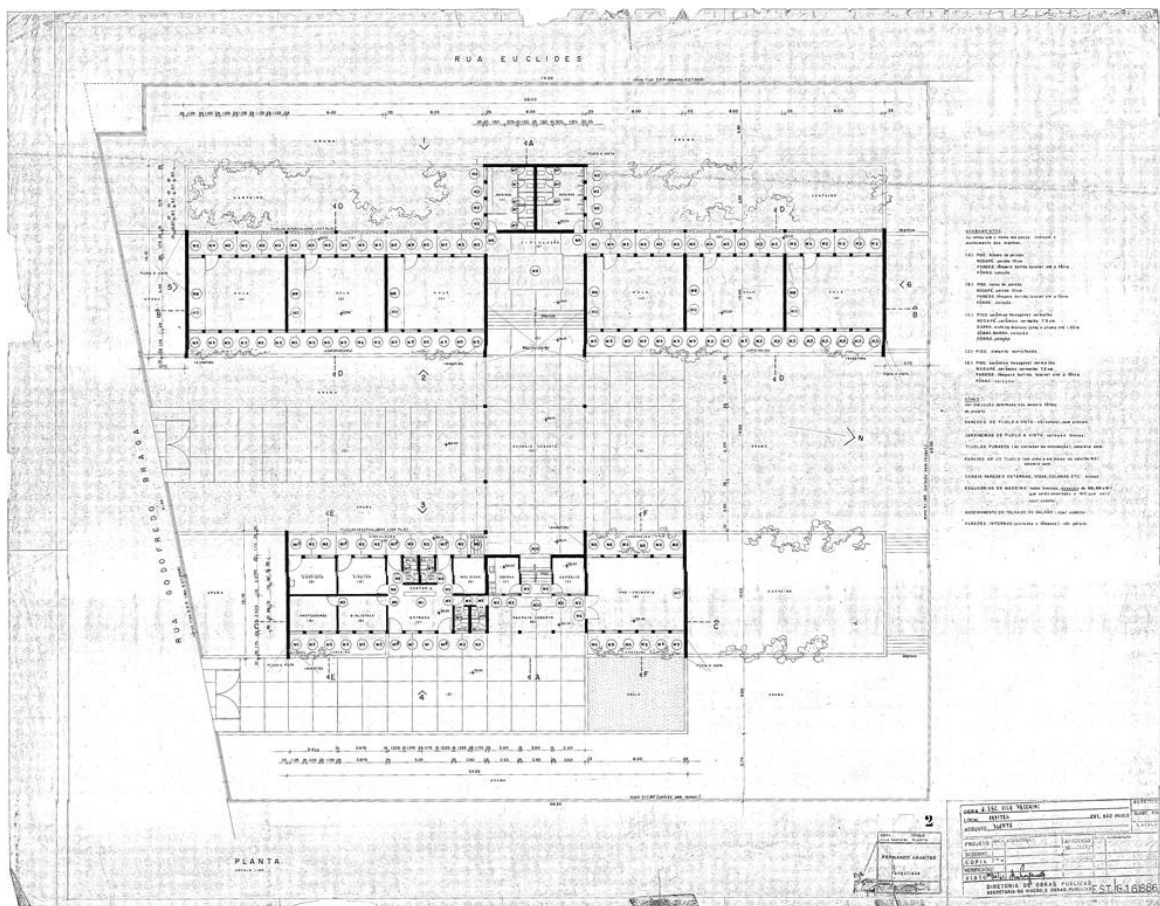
Grupo escolar de Vila Facchini, São Paulo. Arquiteto Fernando Arantes. Planta, 10/out/1960. Fonte: Acervo CPOS
